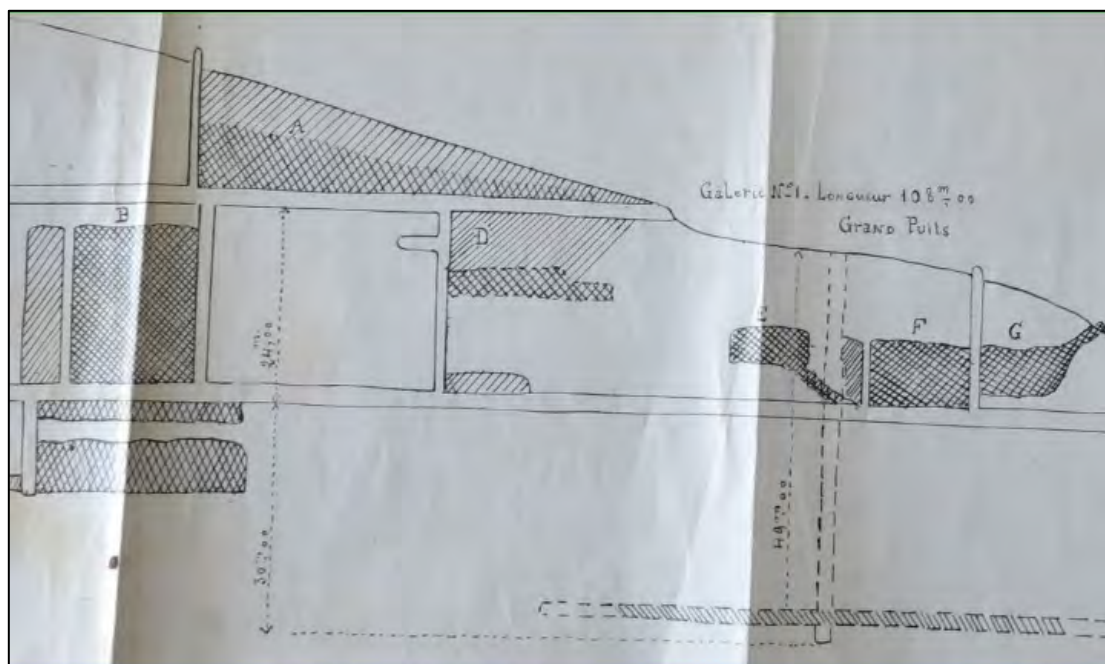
Coupe schématique des travaux de Corent (extrait plan 7)
